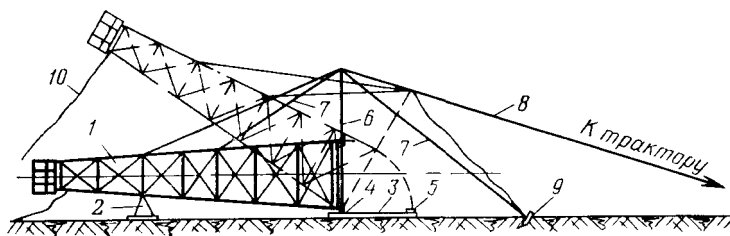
Подъем буровой вышки с помощью стрелы: 1 — вышка; 2 — опора; 3 — основание вышки; 4 — шарнирный башмак; 5 — башмак; 6 — подъемная стрела; 7 — оттяжки стрелы; 8 — подъемный трос; 9 — якорь оттяжки, 10 — трос для удерживания вышки при переходе через мертвую точку
